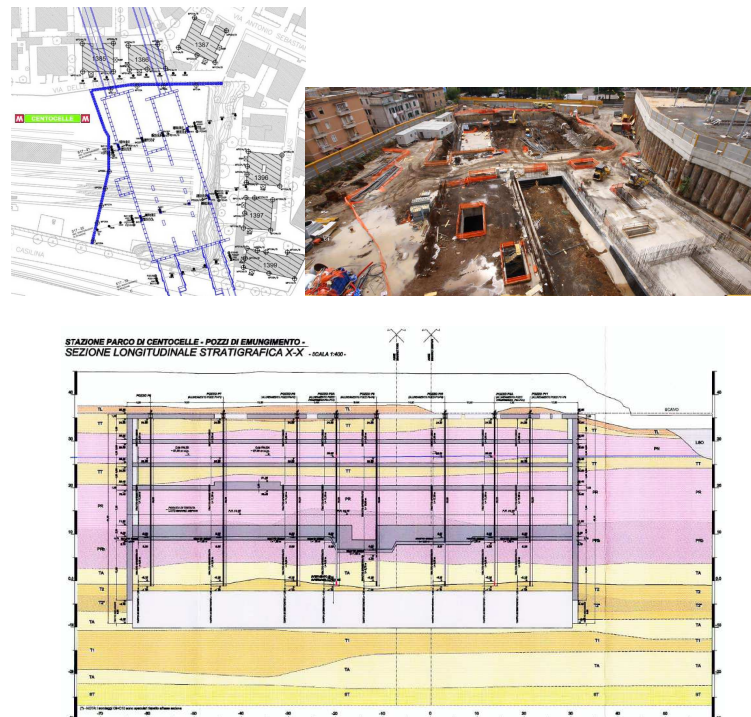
Stazione Parco di Centocelle a) Planimetria e veduta di insieme b) Sezione geotecnica longitudinale
